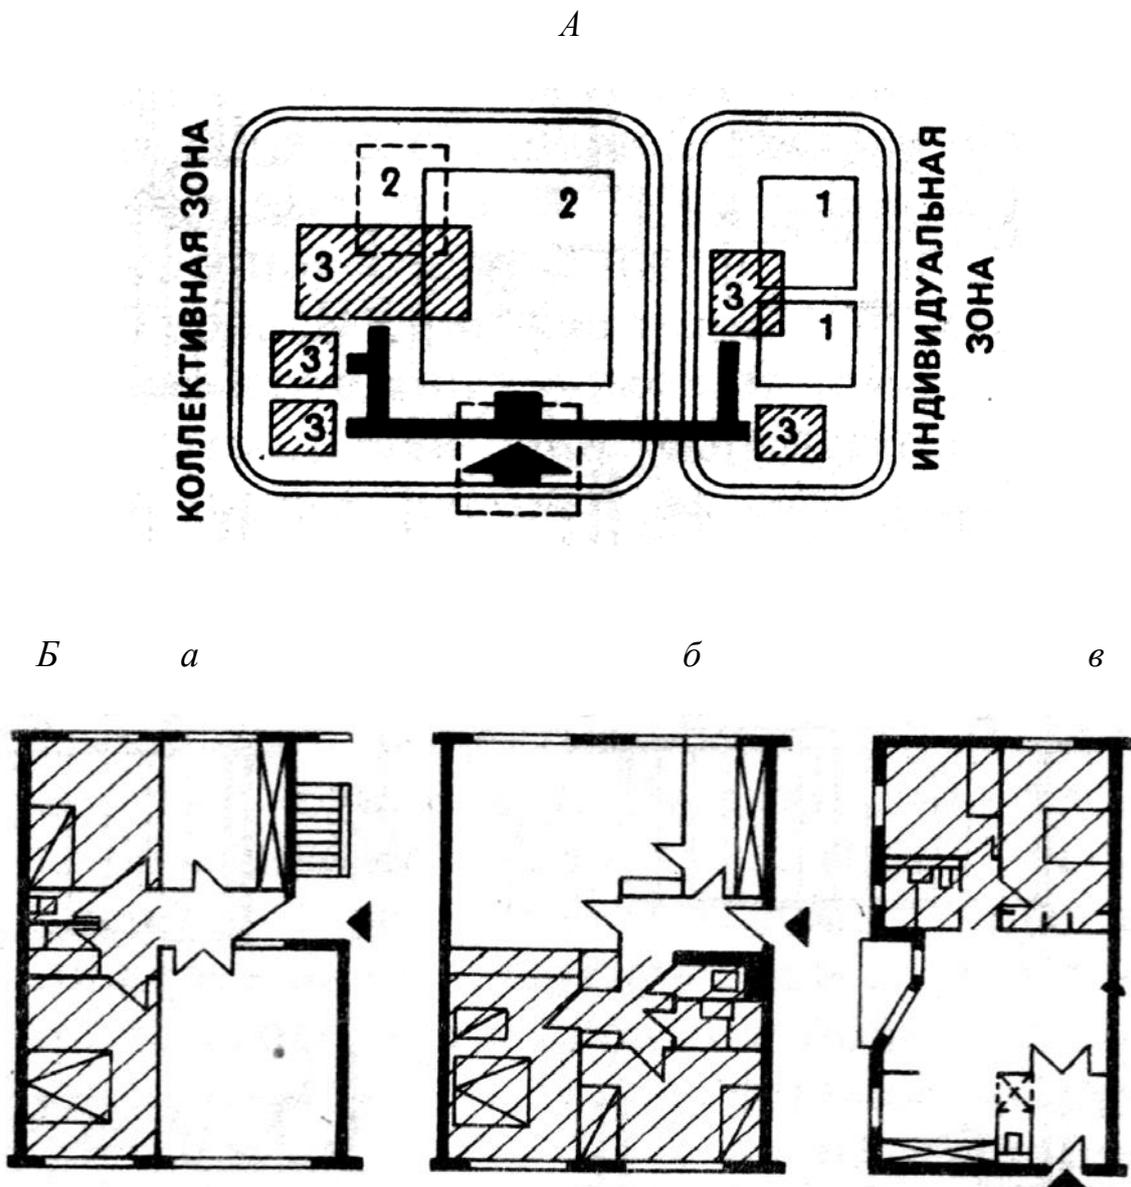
Схема зонирования квартиры с разделением ее на коллективную и индивидуальную зоны (А) 1 – спальня и личные жилые комнаты; 2 – комната общесемейного отдыха, столовая; 3 – подсобные помещения (кухня, санузел, коридоры). Планировочные приемы квартир с зонированием на коллективную и индивидуальную зоны. (Б) а – индивидуальная зона в глубине квартиры — имеет связь с передней; б – индивидуальная зона по одну сторону входа в квартиру, коллективная – по другую; в – зонирование квартиры с проходом в индивидуальную зону через коллективную
